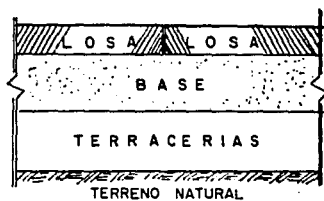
Capas que forman la estructura de un pavimento rígido.
